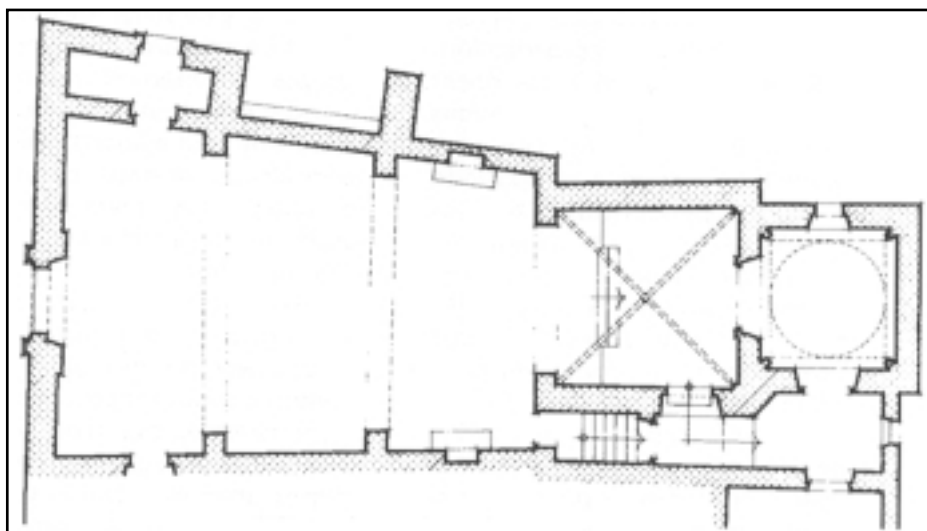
Planta de la ermita de Ntra. Sra. de los Ángeles
